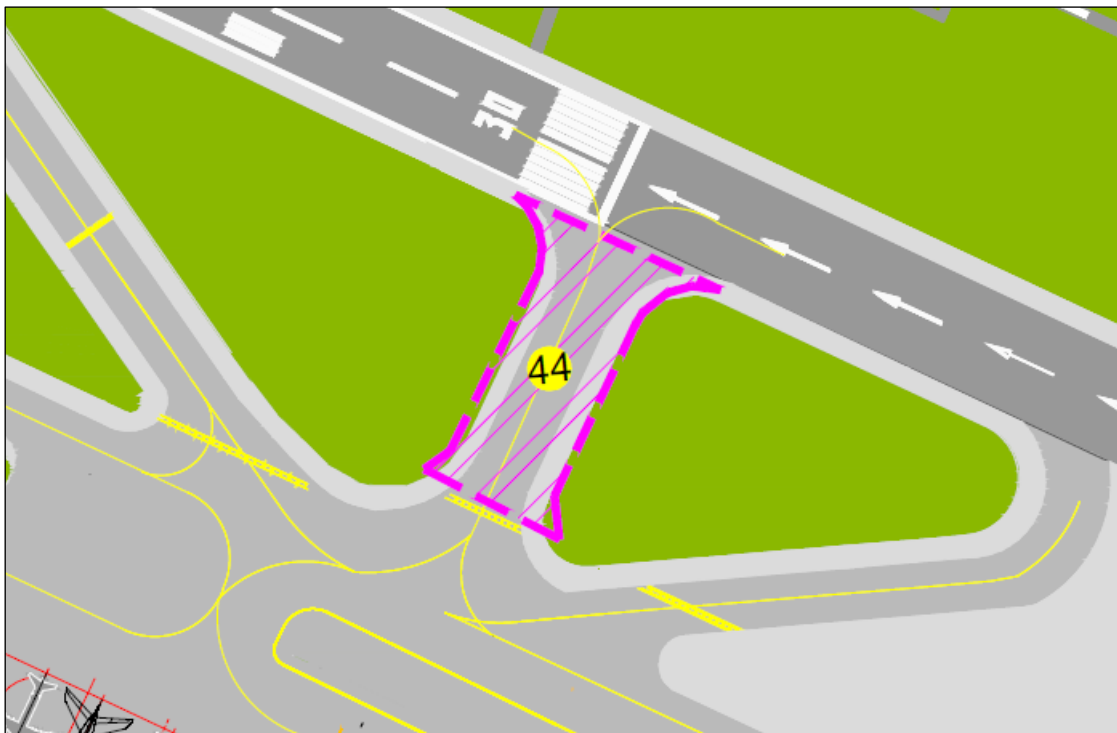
Estratto Master Plan – Riqualifica Taxiway Hotel
